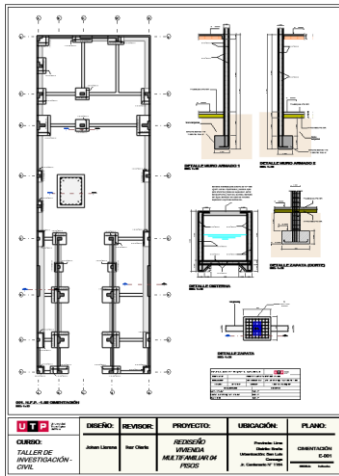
Planos generados con la metodología BIM utilizando Revit 2025
